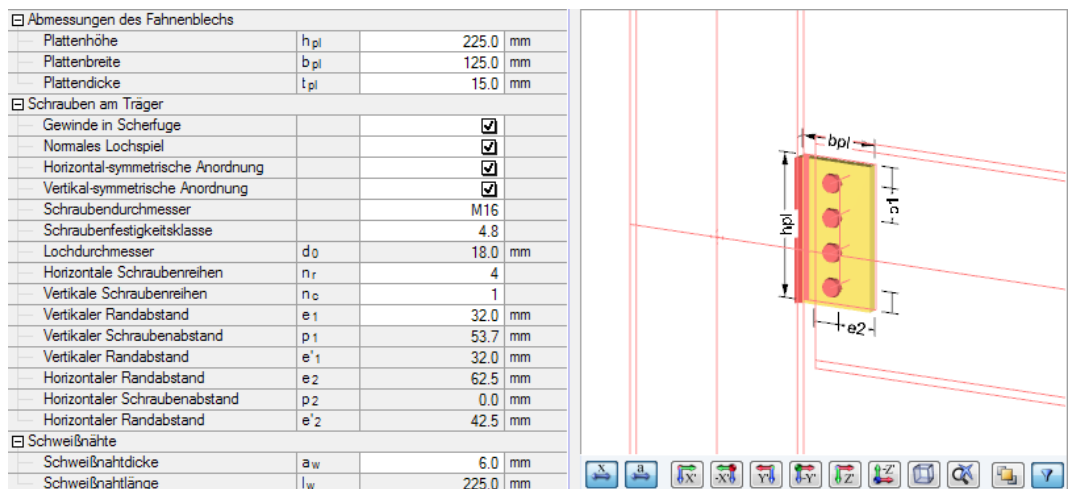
Abmessungen des Fahnenblechs, Schrauben- und Schweißnahtparameter festlegen
